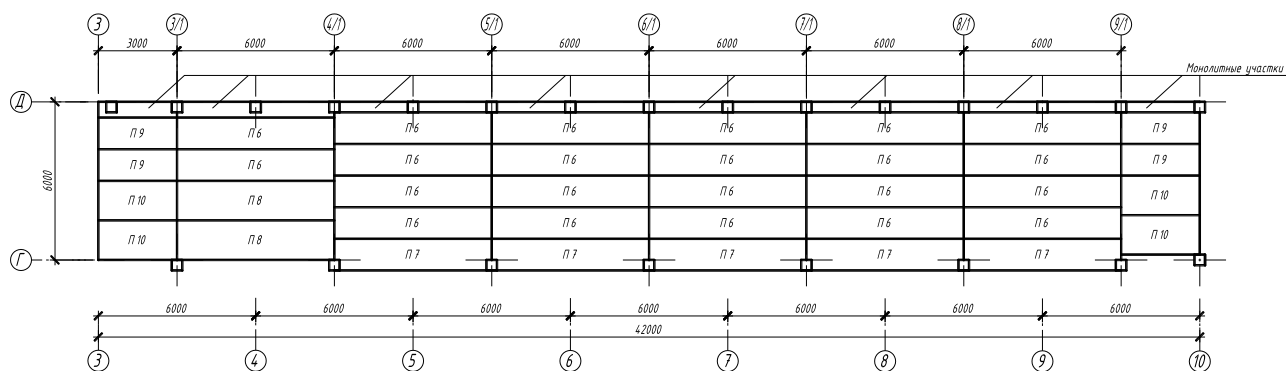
Схеми розташування плит перекриття в осях 3-10 і Г-Д
